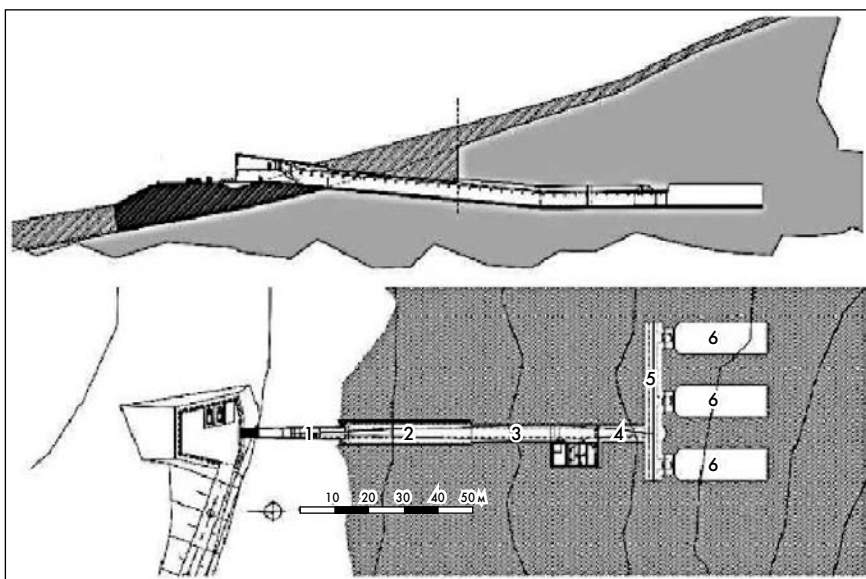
Вверху разрез по хранилищу, внизу — план хранилища.
